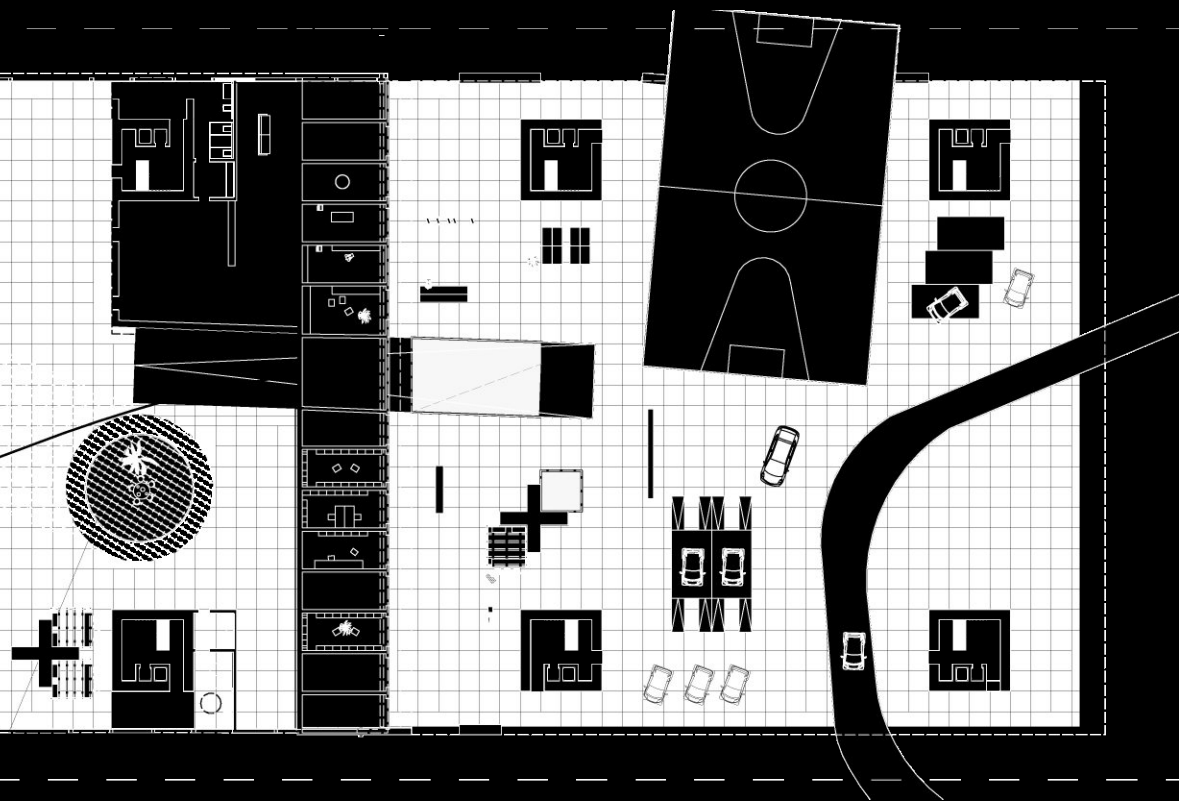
Grundriss der Ebenen 0 bis -2 / Öffentlich
